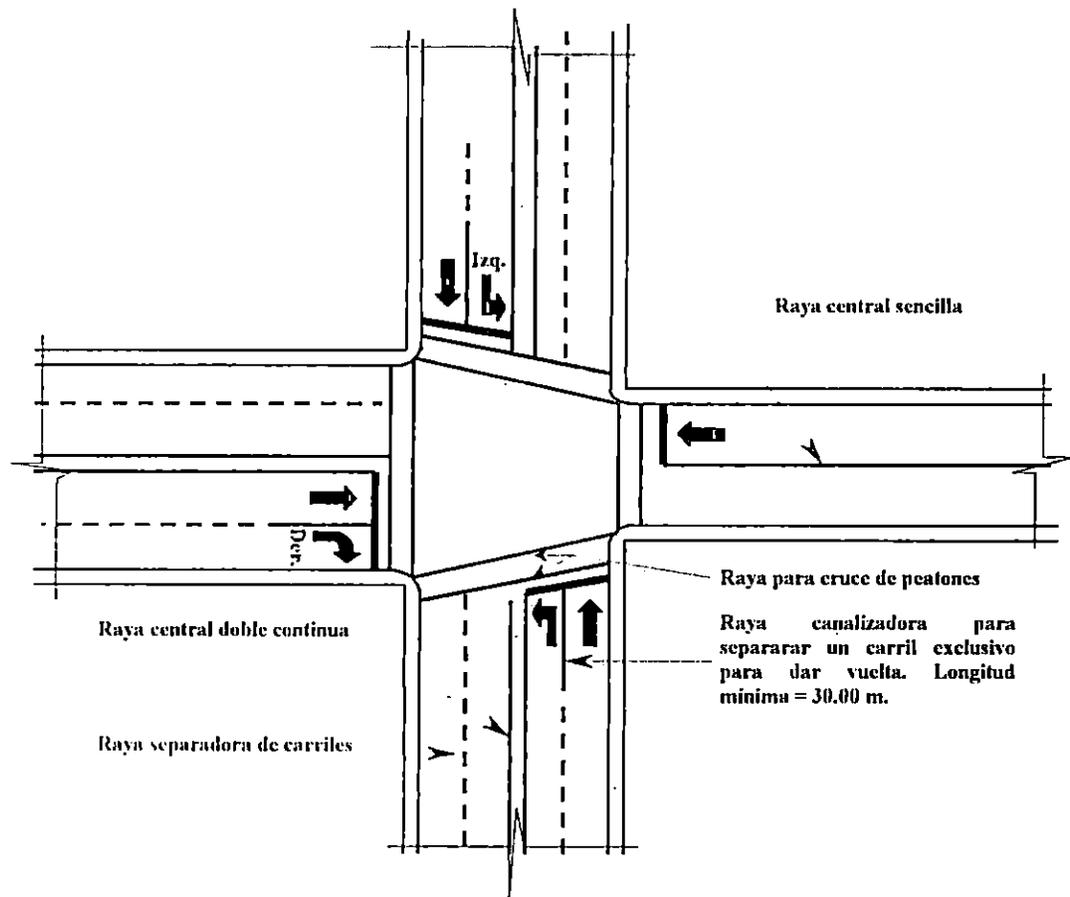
Diversos tipos de rayas y marcas en el pavimento.
